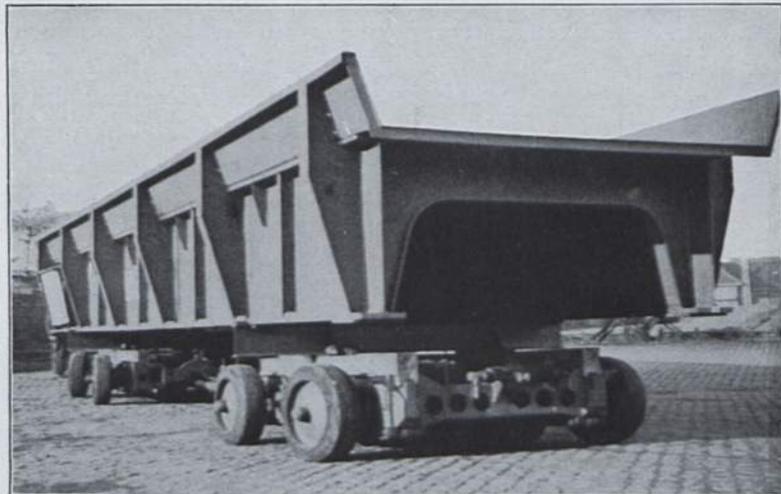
Eine geschweißte Eisenbahnbrücke wird über die Straße gefahren. (Foto Reichsbahn.)
